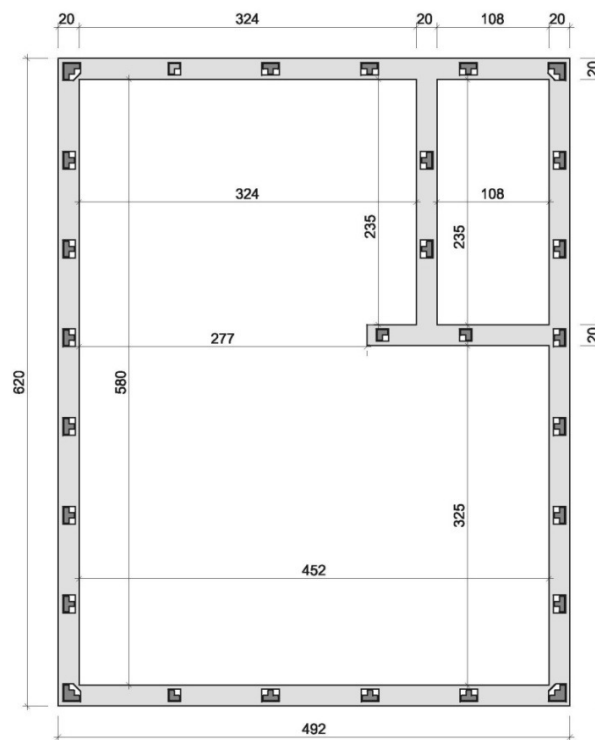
Planta baixa das vigas de fundação do projeto da residência de 29,28m².
